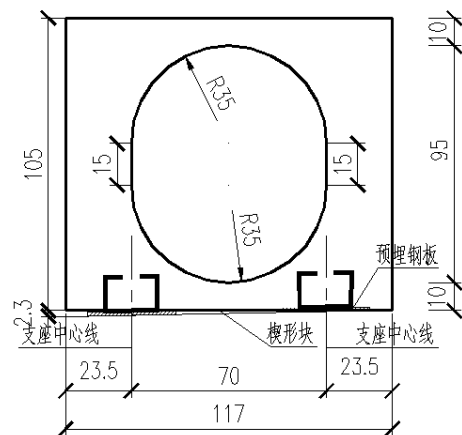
中板-支截面 (尺寸单位:cm)
